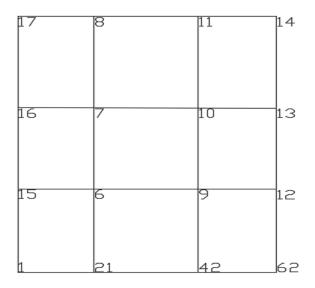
Codificación de planta de la edificación Fuente: Sap2000 v.18.2
